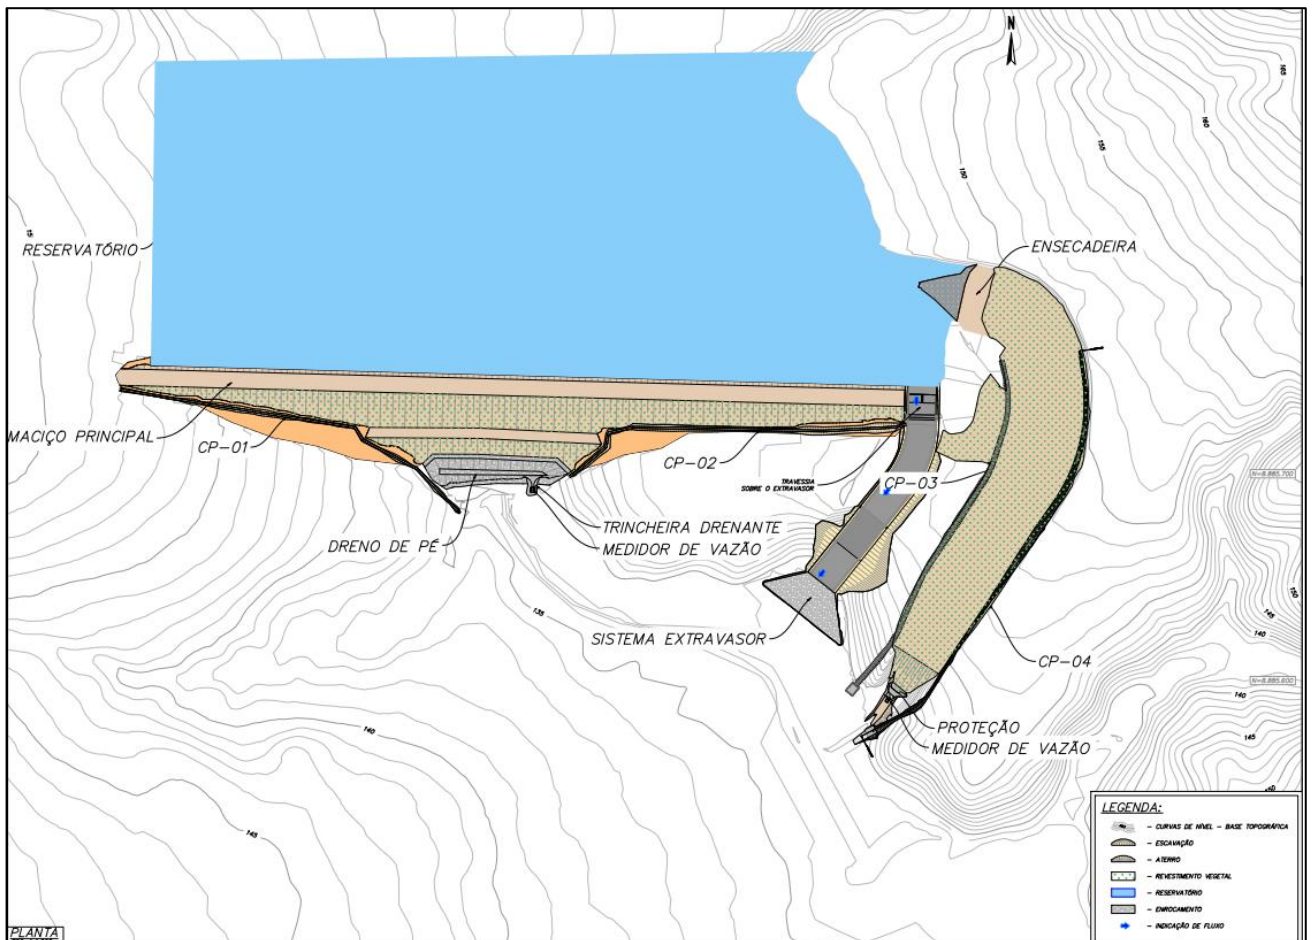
Arranjo Geral da Barragem de Água Aripuanã (Fonte: Adaptado de projeto detalhado, DF+, 2020).
